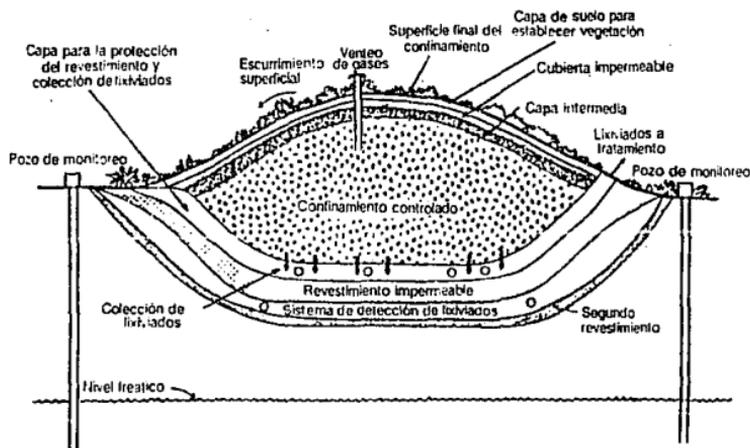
Esquema de la sección transversal de un confinamiento terminado y cerrado. Fuente: Batstone, Vol II, 1989
